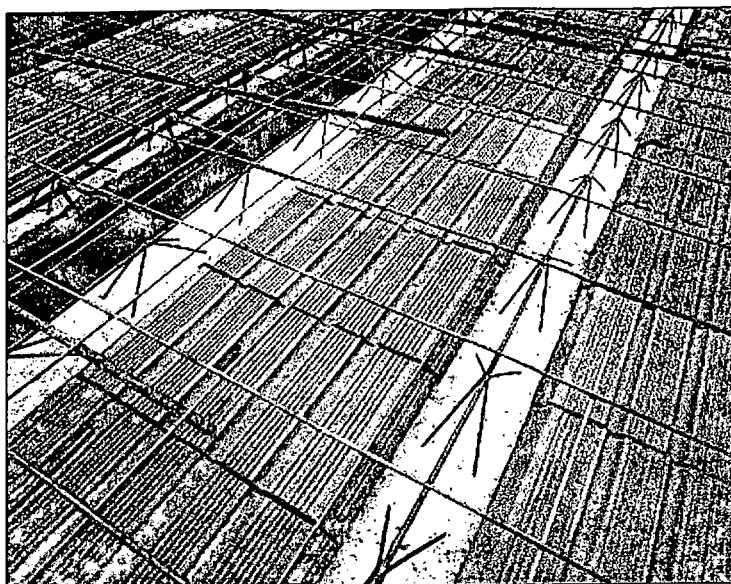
Laje treliçada (neste exemplo, verifica-se também a utilização da tela).
